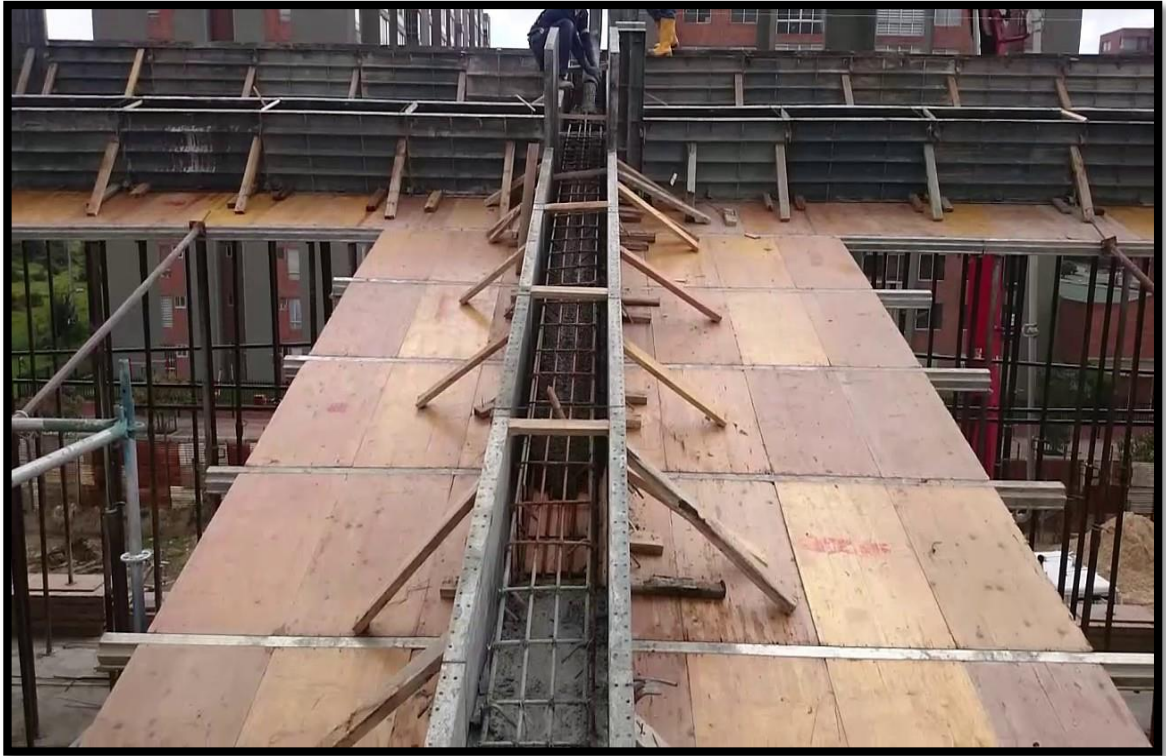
Encofrado en viga. *Fuente:* Elaboración propia
